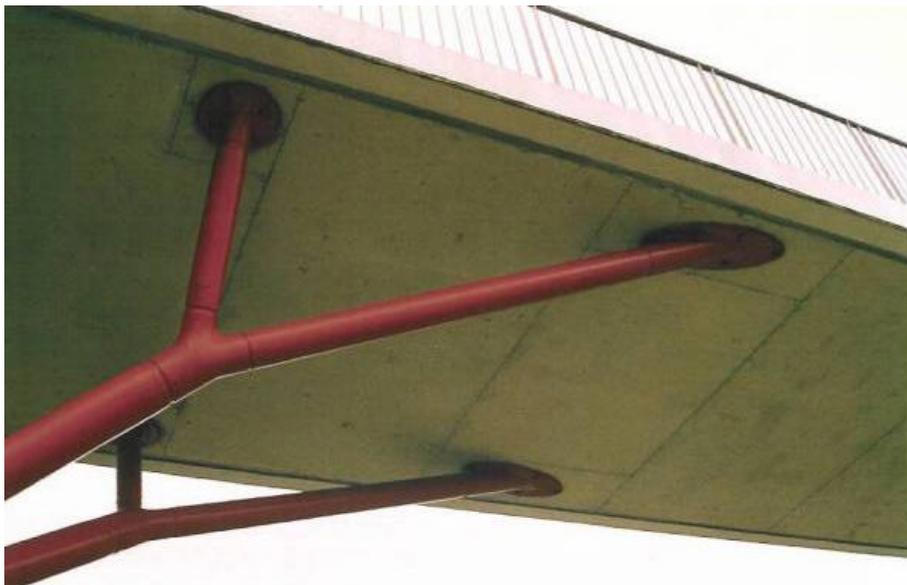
Tabuleiro em concreto, pilares tubulares tipo arvore. Pragsattel, Stuttgart.
